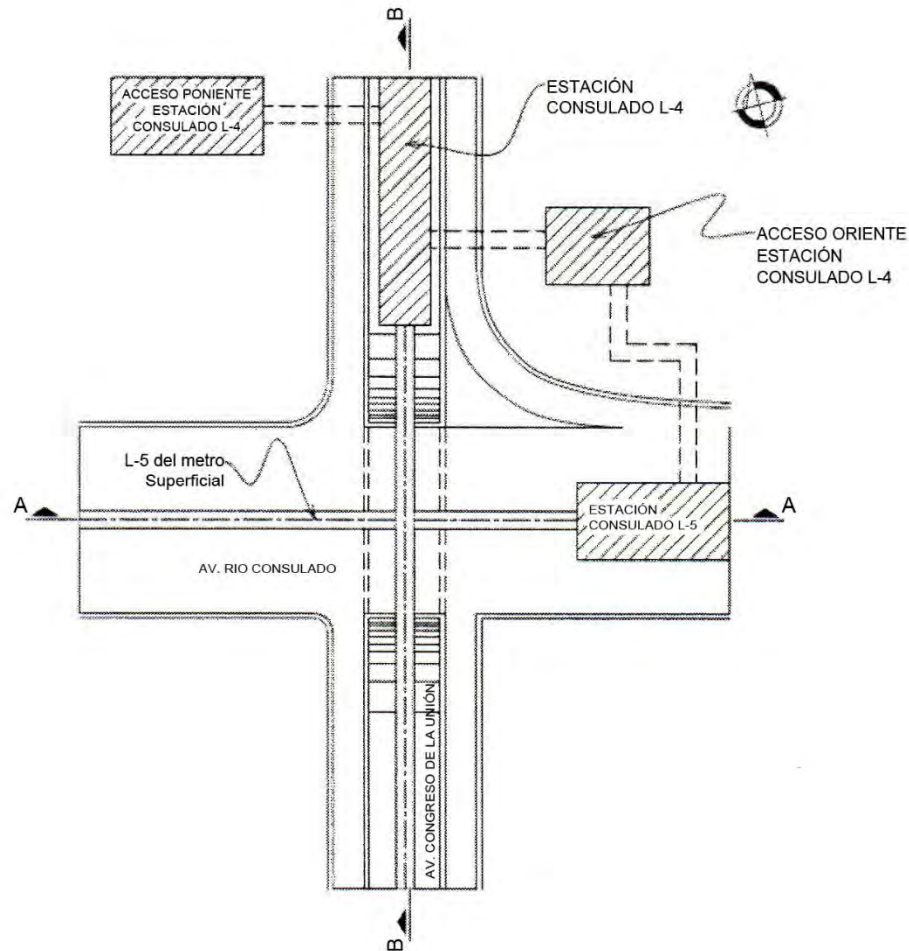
Planta del cruce de las Av. Congreso de la Unión y Río Consulado.
